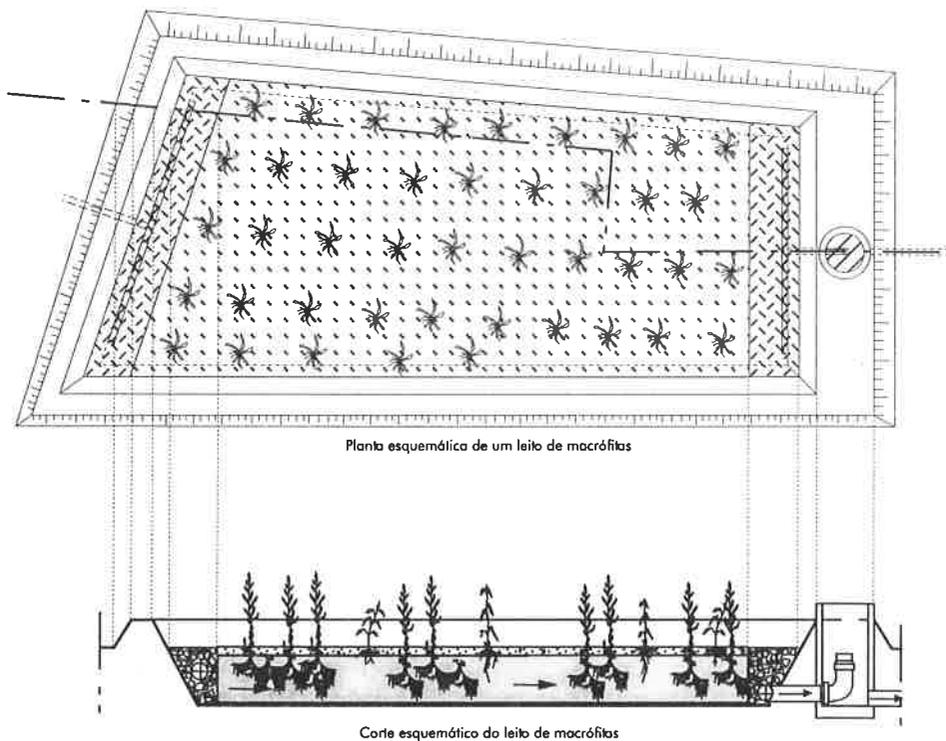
Leito de macrófitas (planta esquemática e corte)
